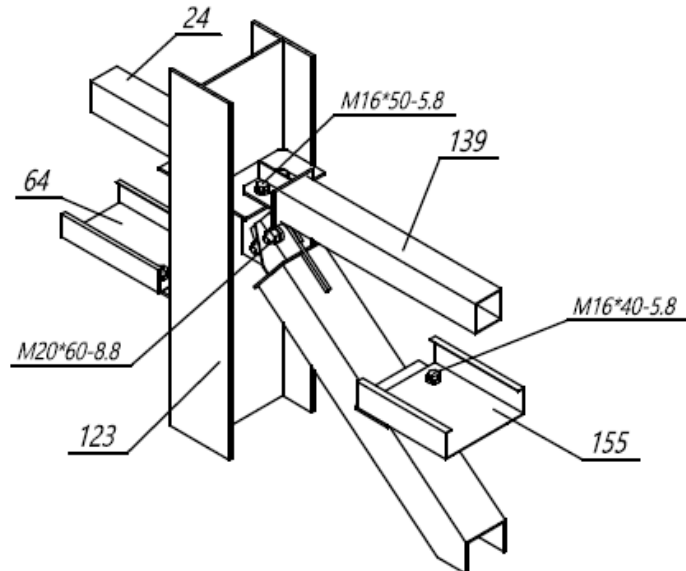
Узел соединения горизонтальных балок, связей с несущими колоннами
